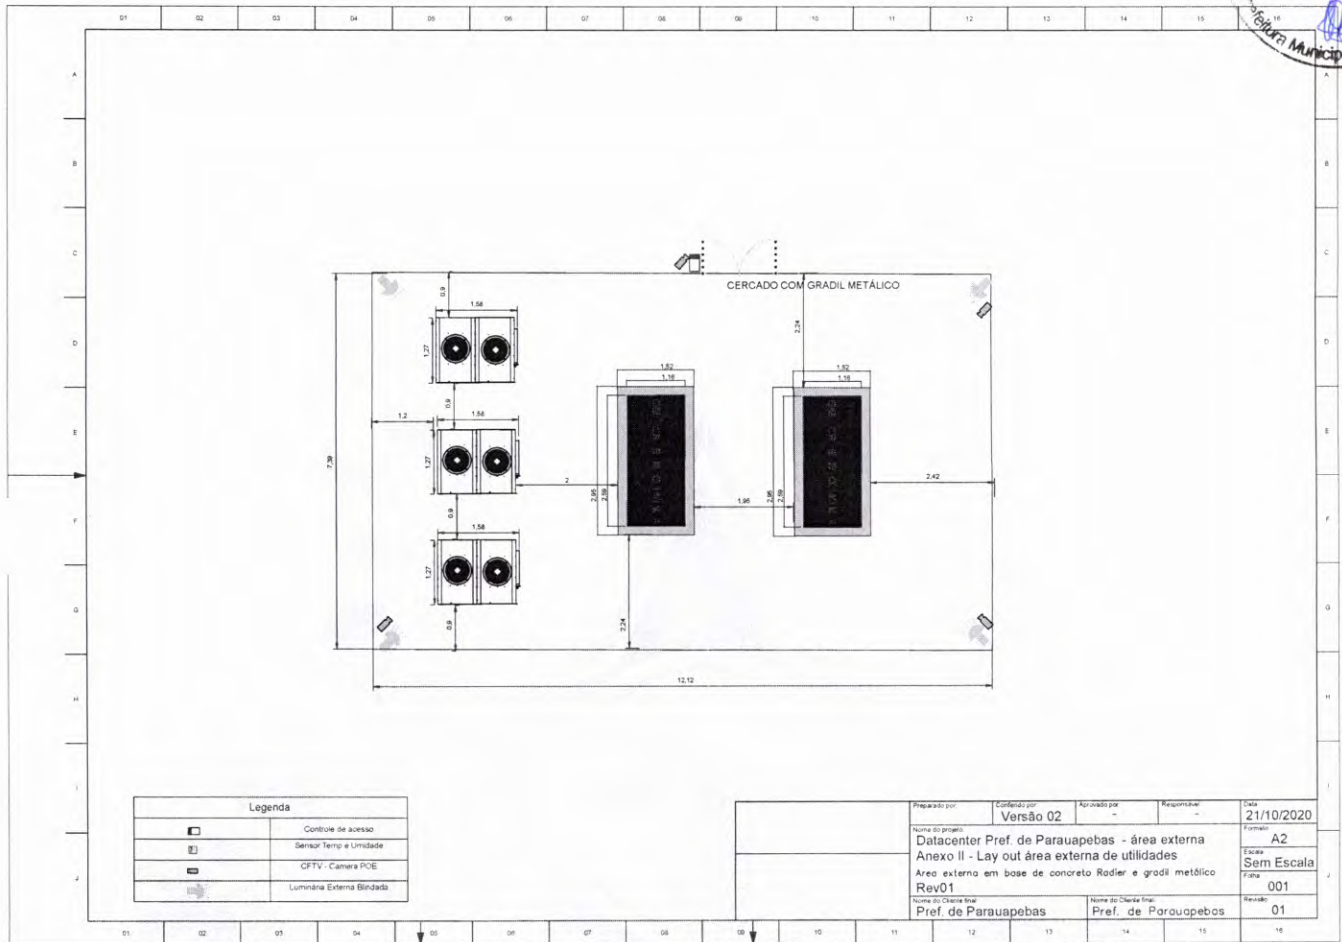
Planta de Layout da área de condensadoras e GMG
